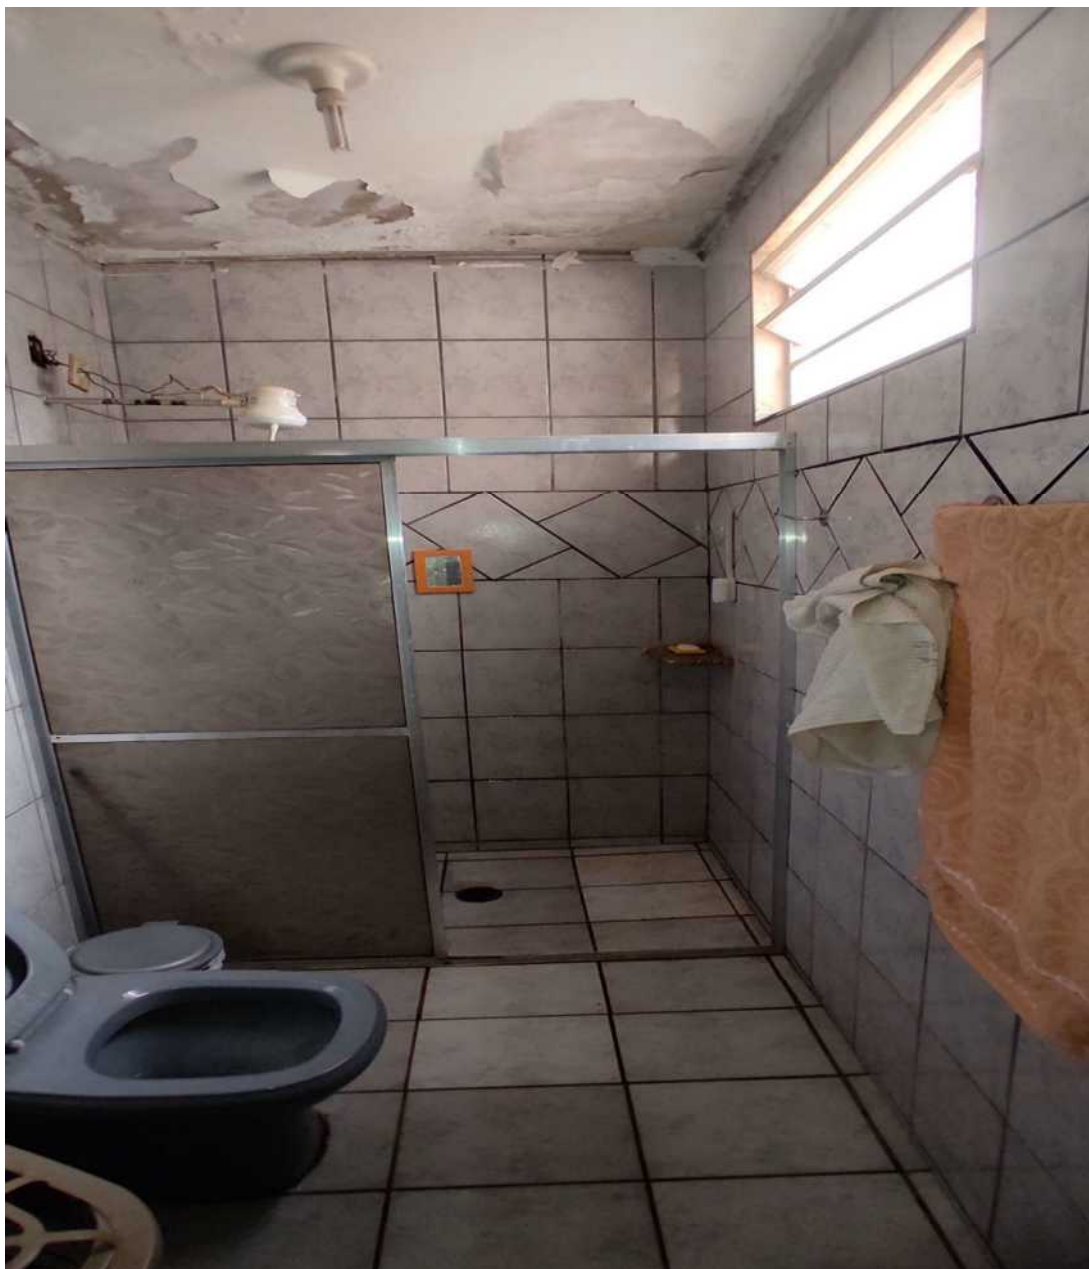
Banheiro em Piso ceramico, acabamento ceramico até o teto, Laje premoldada concreto, sanca em gesso, box de Acrílico, Pintura Latex e sinais de Vazamento do Telhado na laje.
